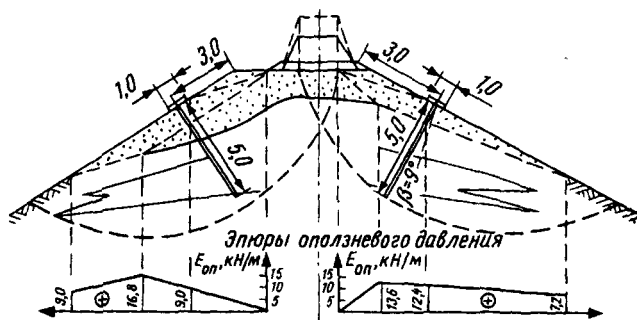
Расчетная схема усиления насыпи анкерными конструкциями. (Размеры в м)
